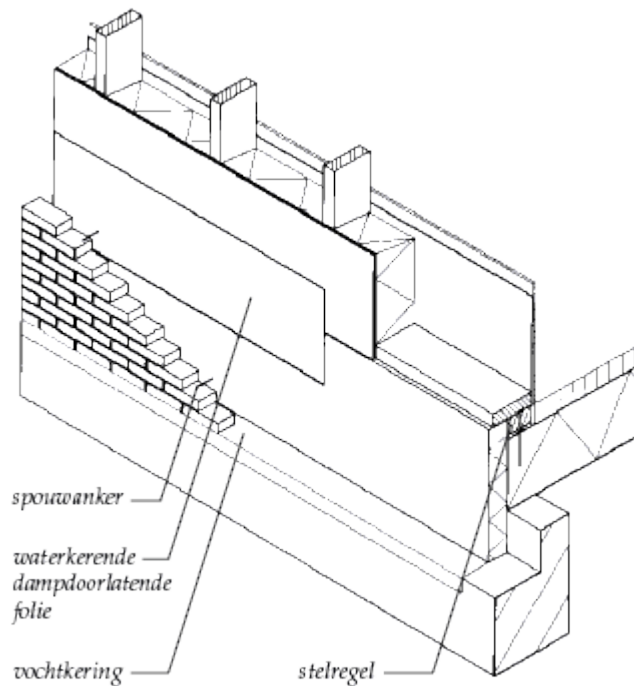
Aansluiting buitenwandelement met begane grondvloer en fundering [6]
